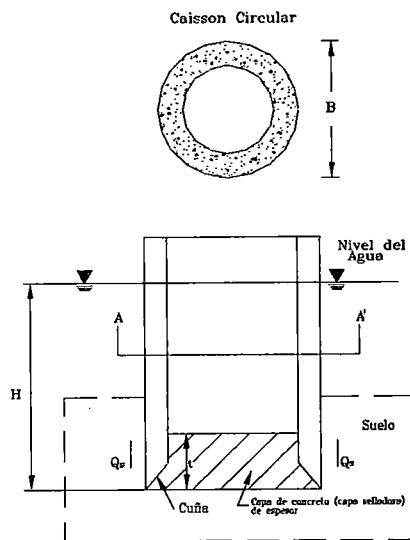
Detalle del Caisson Abierto para la Cimentación del Puente Yuracyacu
